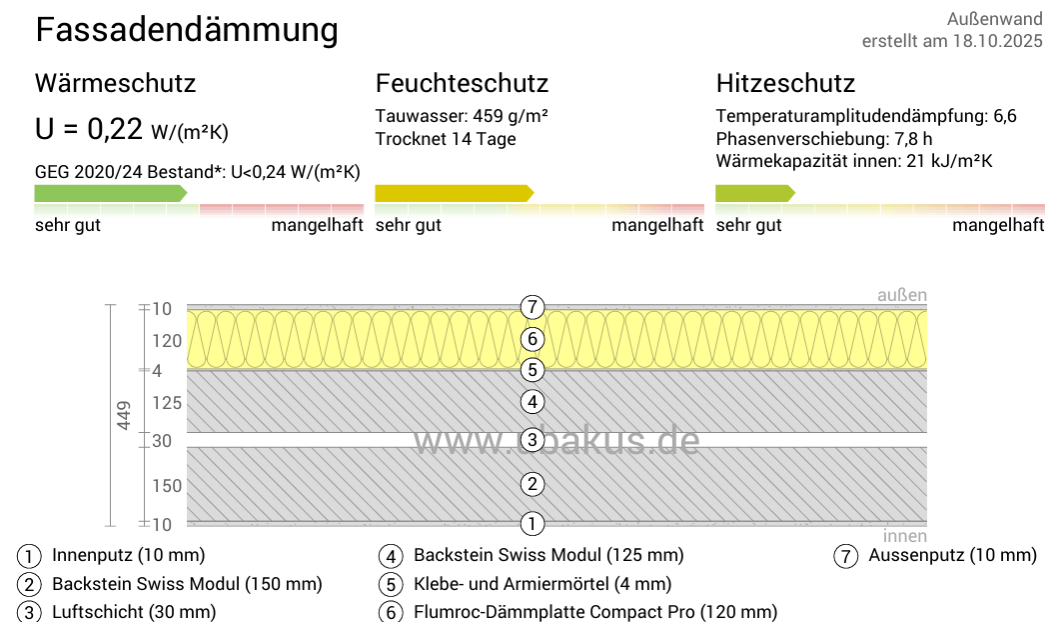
Konstruktion Fassadendämmung mit U-Wert Ubakus
